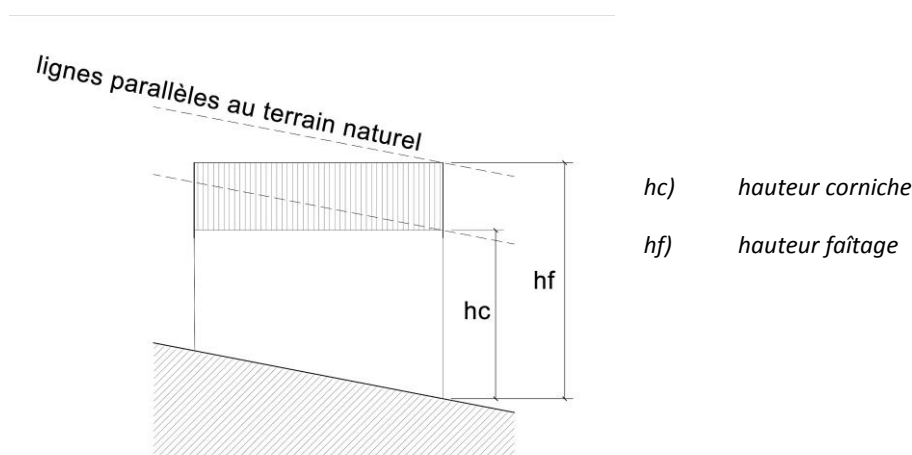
Hauteurs des constructions dans le cas de la voirie desservante en pente
